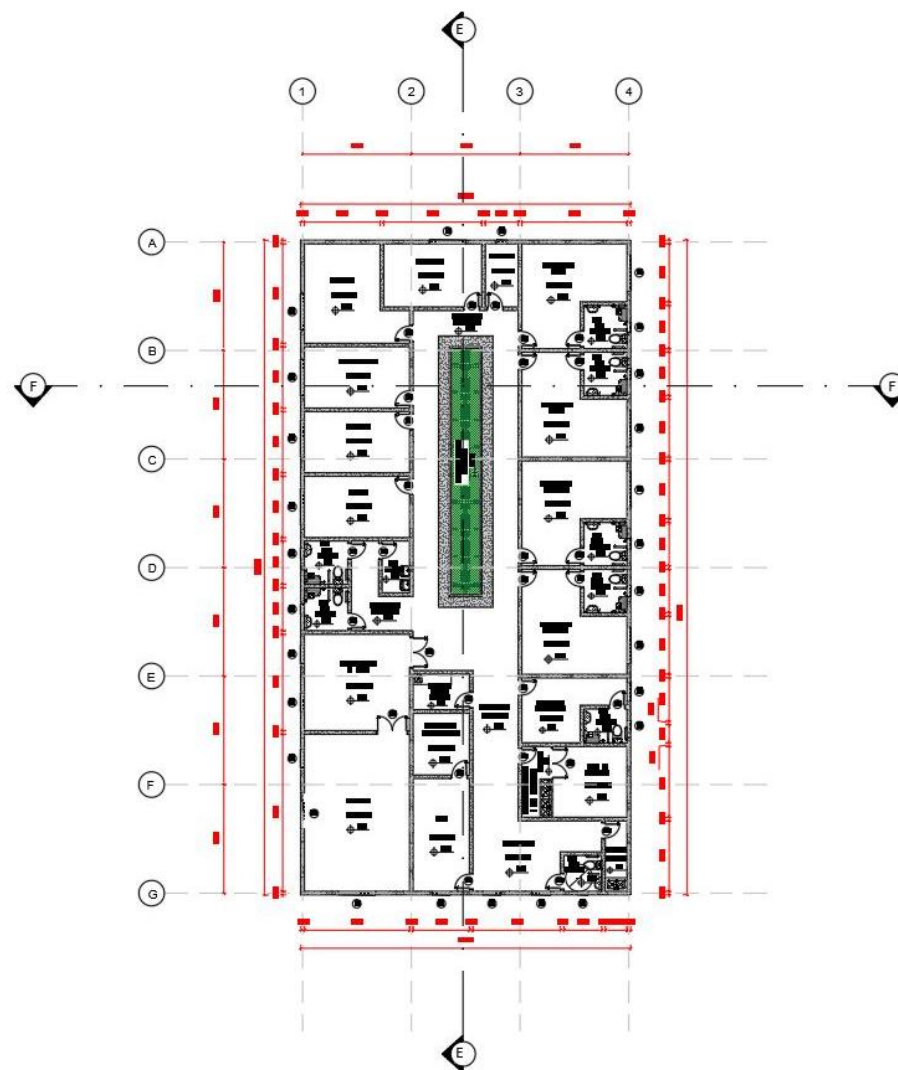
Planta Técnica – Fonte: Acervo Próprio
